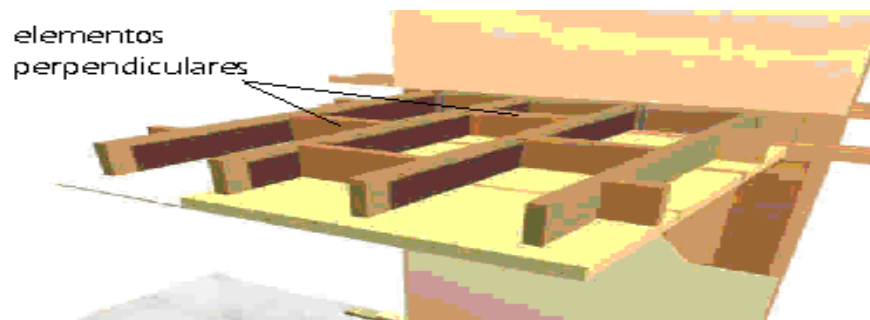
Elementos perpendiculares unidos a las vigas secundarias.
